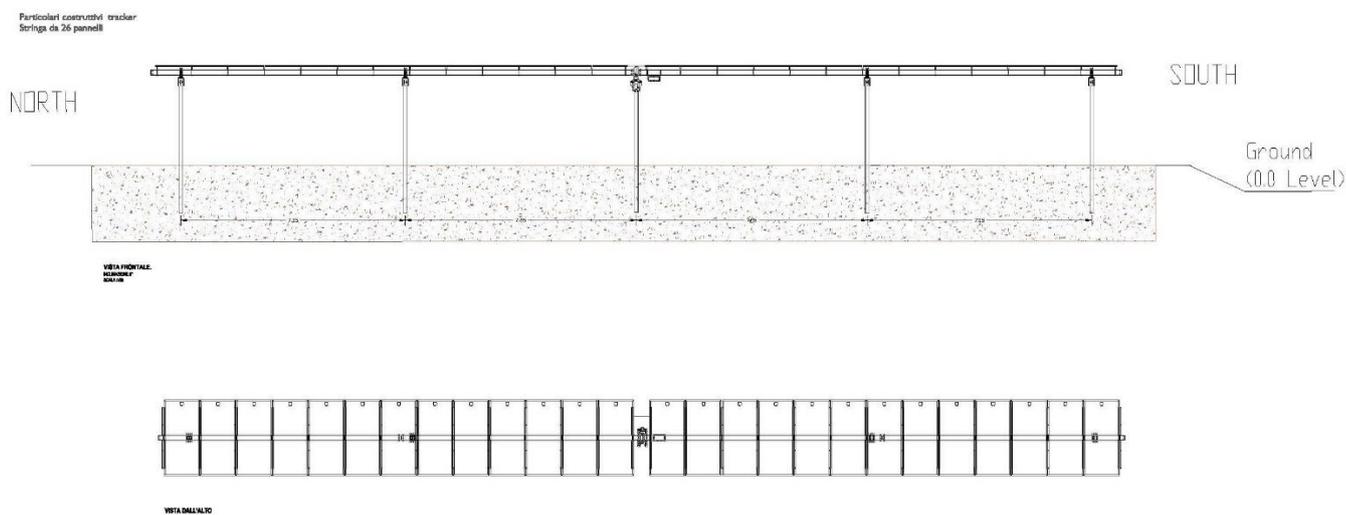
Vista laterale e vista dall'alto della singola stringa da 26 moduli
